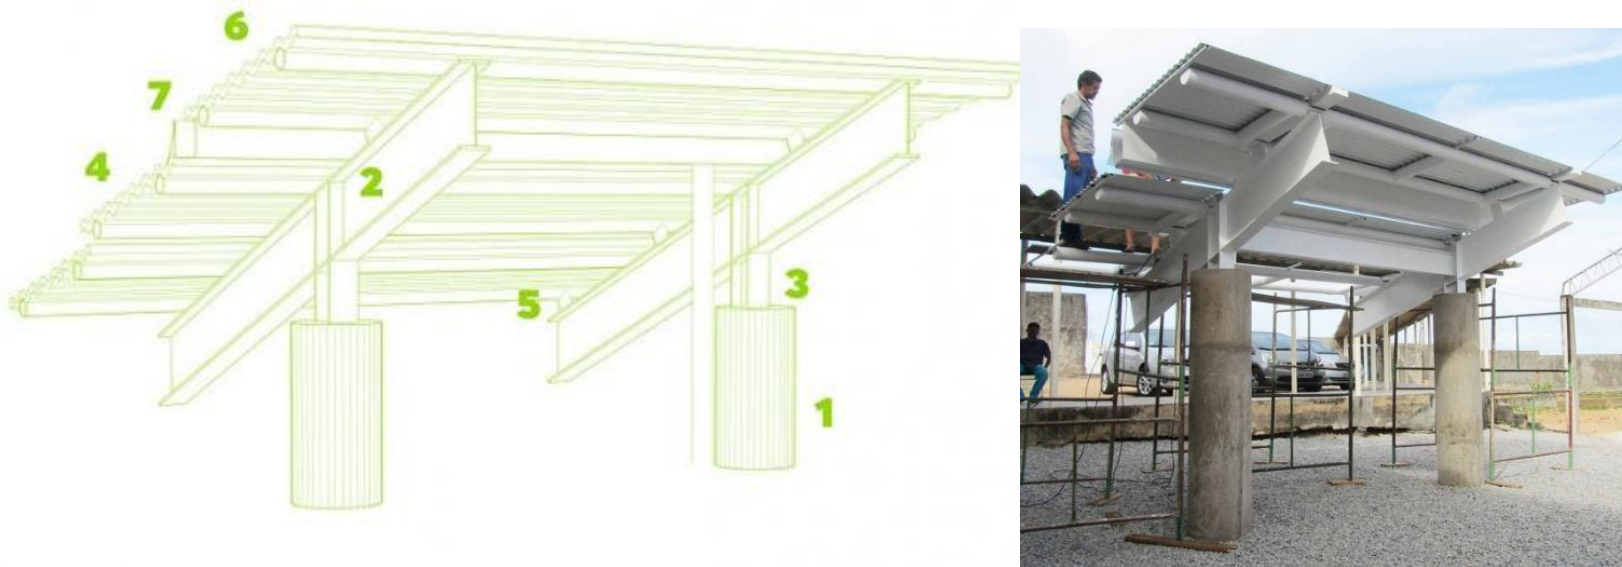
Caracterização do telhado | Fonte: Archdaily
